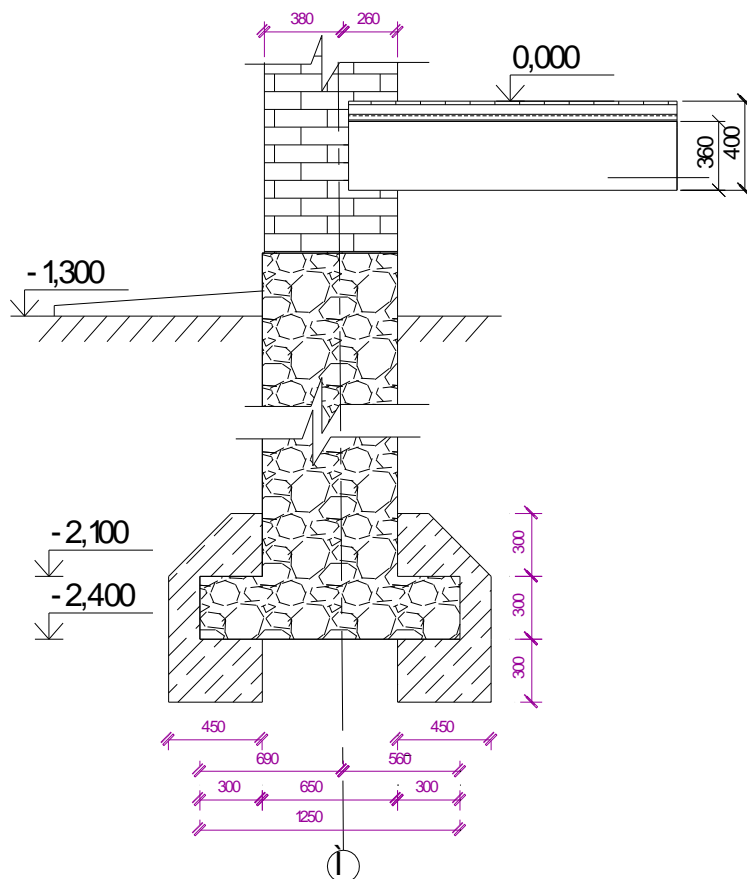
Усиление фундамента под наружную стену с омоноличиванием уступа.
